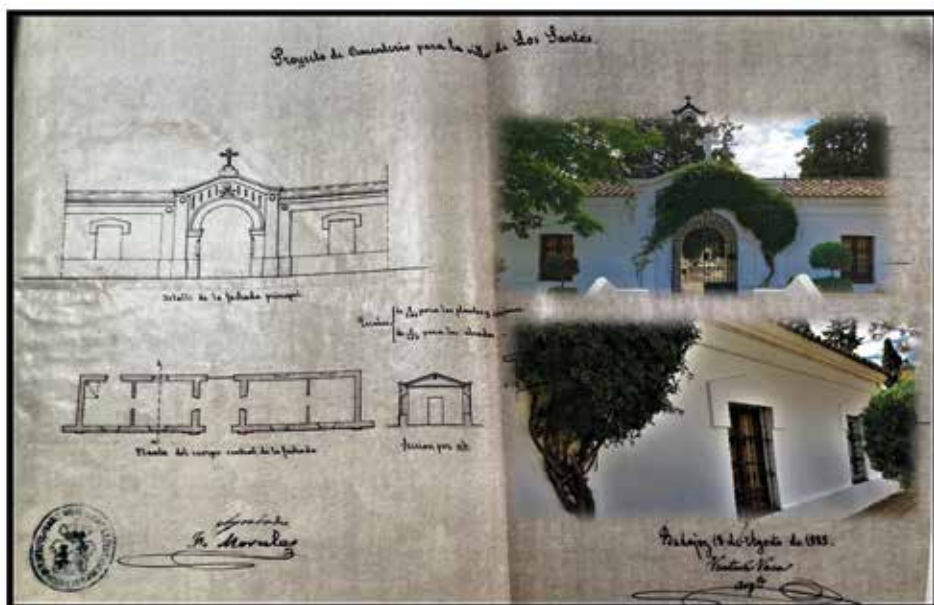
a. 791. Plano de la fachada. Fuente: Archivo Municipal de los Santos de Maimona, sección de vías y obras del año 1883.
